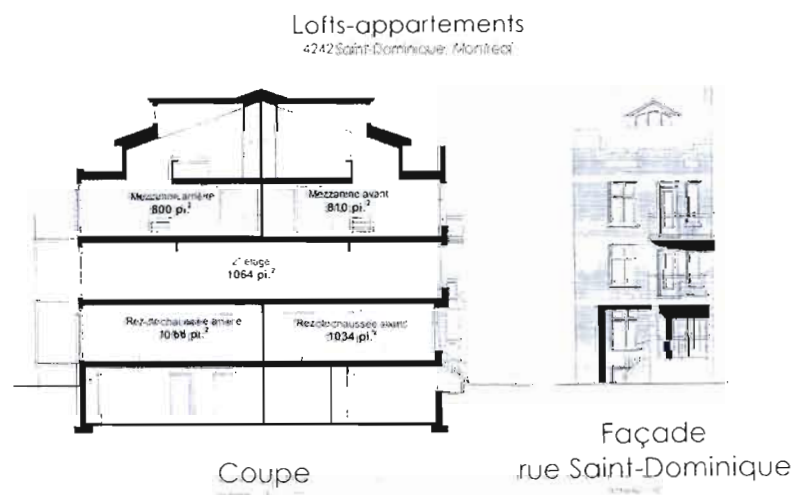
Élévation de la façade principale et plan en coupe du 4242, rue Saint-Dominique. Source : Archives Jocelyn Duff.
